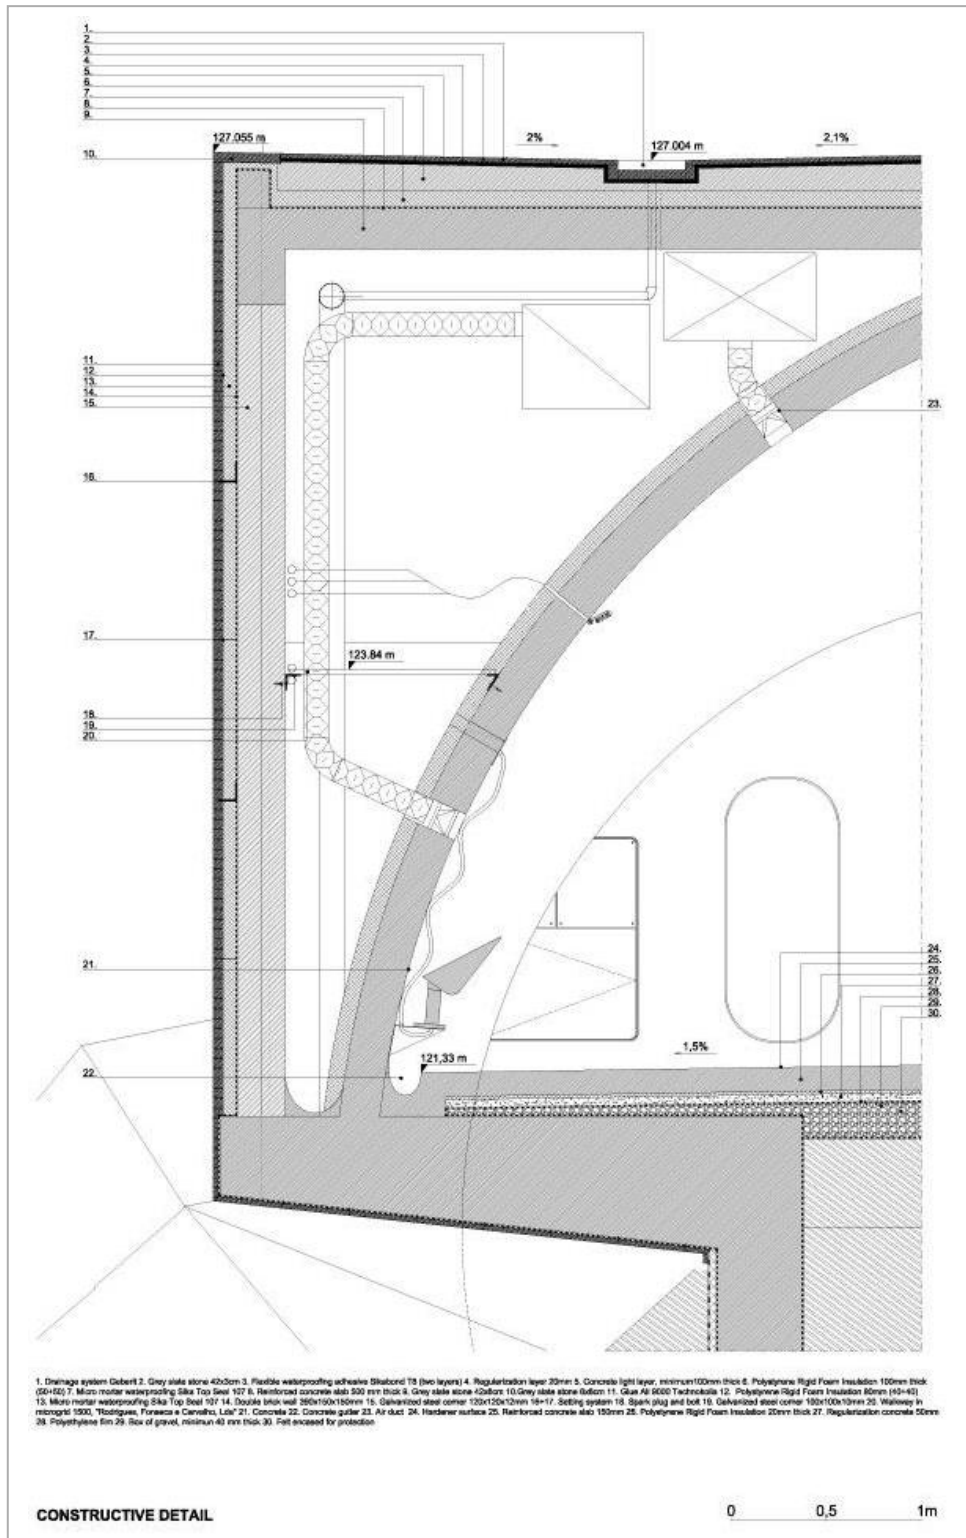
Corte construtivo da cave das barricas da Adega da Quinta do Vallado; Fonte – [internet] Disponível em: <https://divisare.com/projects/202621-Menos-Mais-Arquitectos-Quinta-do-Vallado-Winery#>.
